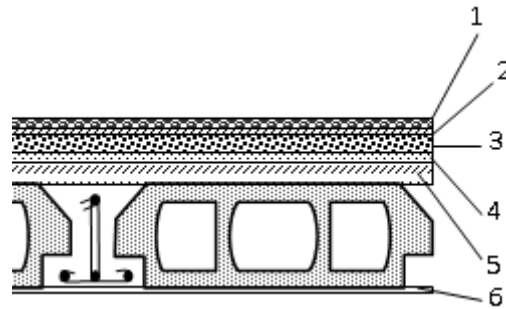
Coupe transversale d'un plancher d'étage courant.
